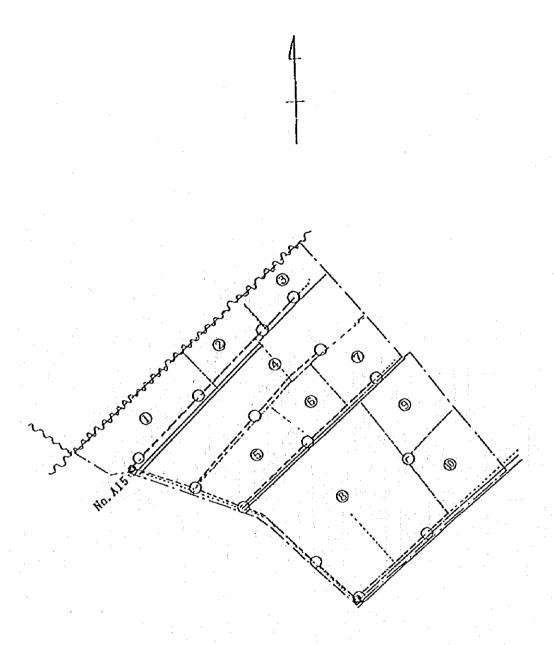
Plan horizontal du projet des installations terminales (Mansoura)
